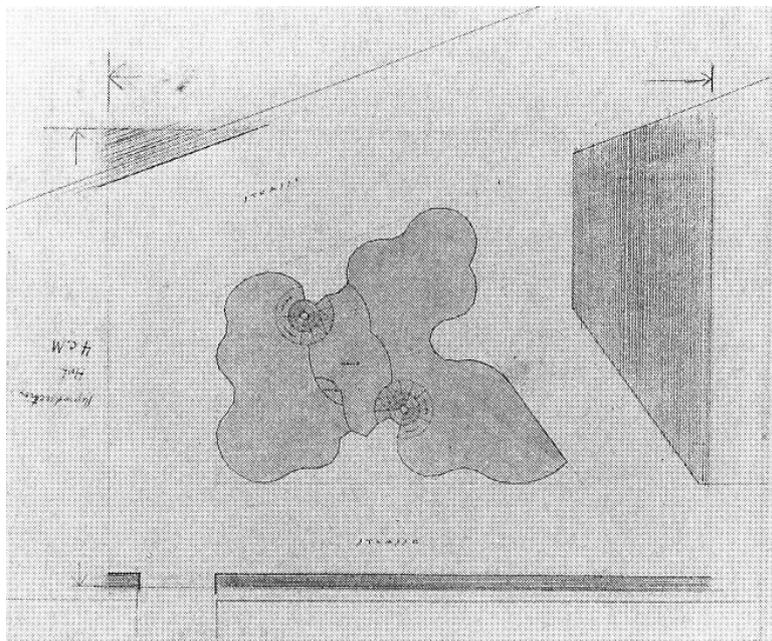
Mies van der Rohe, Entwurf für ein Glashochhaus, 1922, Grundriss
